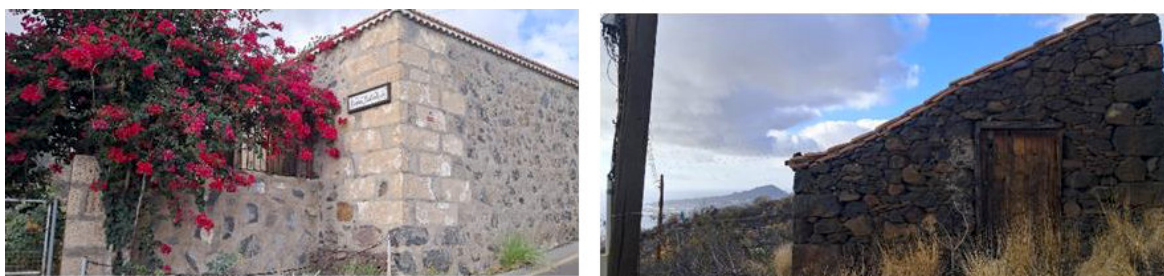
Imagen izq. Muro de mampostería de tosca y basalto. Imagen dcha. Muro de mampostería de basalto.
